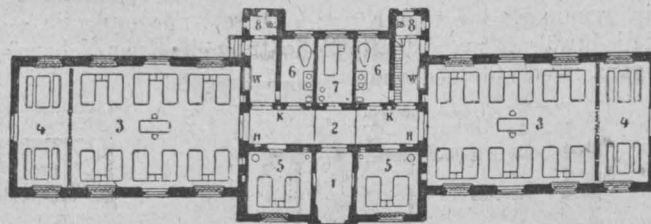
Interner Pavillon, Erdgeschoß; Allg. Krankenhaus in Aussig a. Elbe
